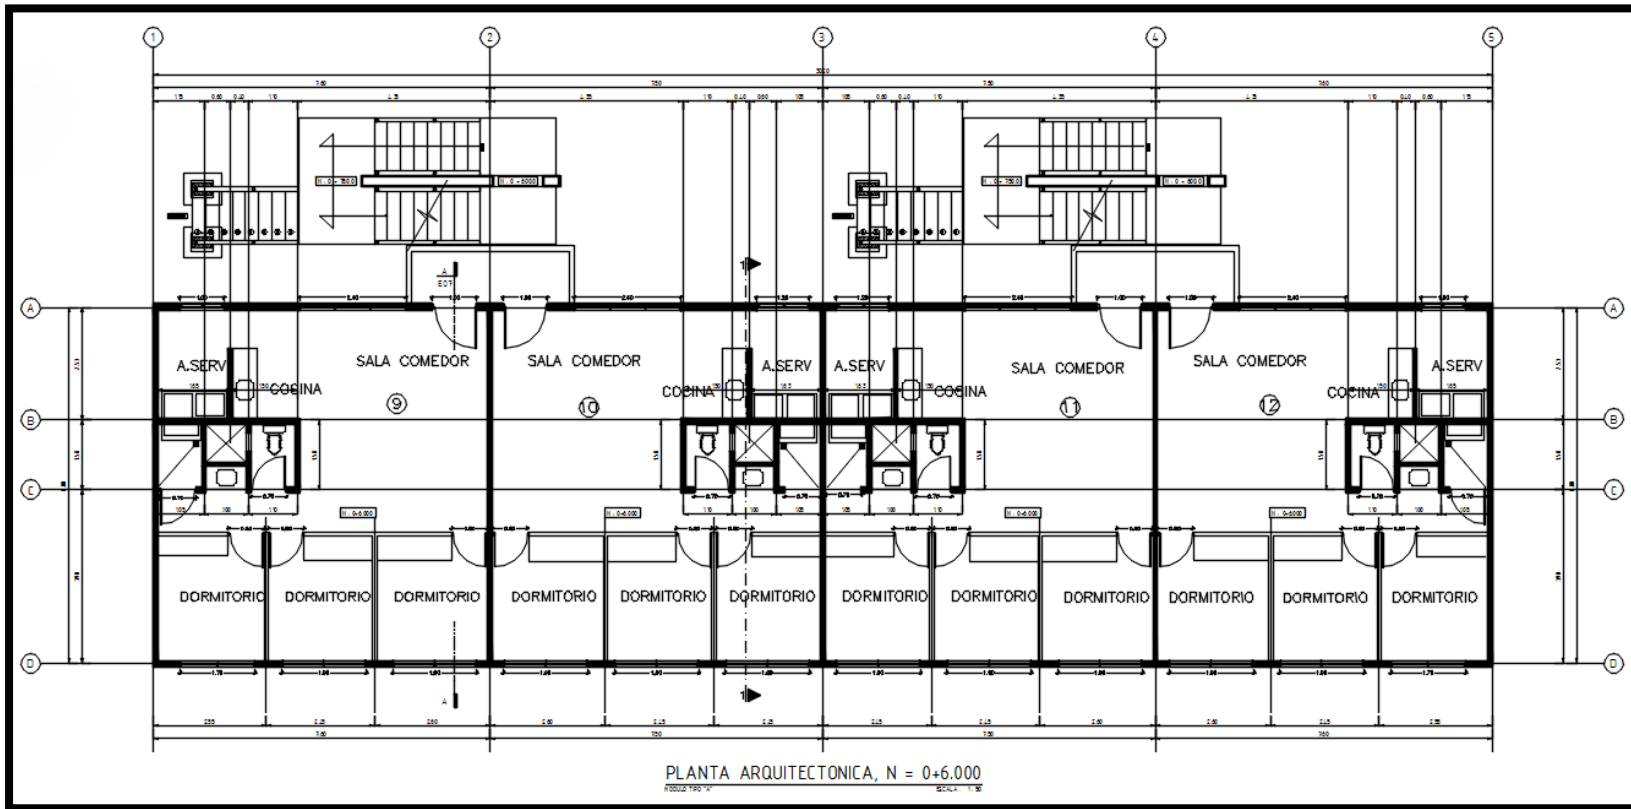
Planta Arquitectónica (Elevación 0 + 6.000)
